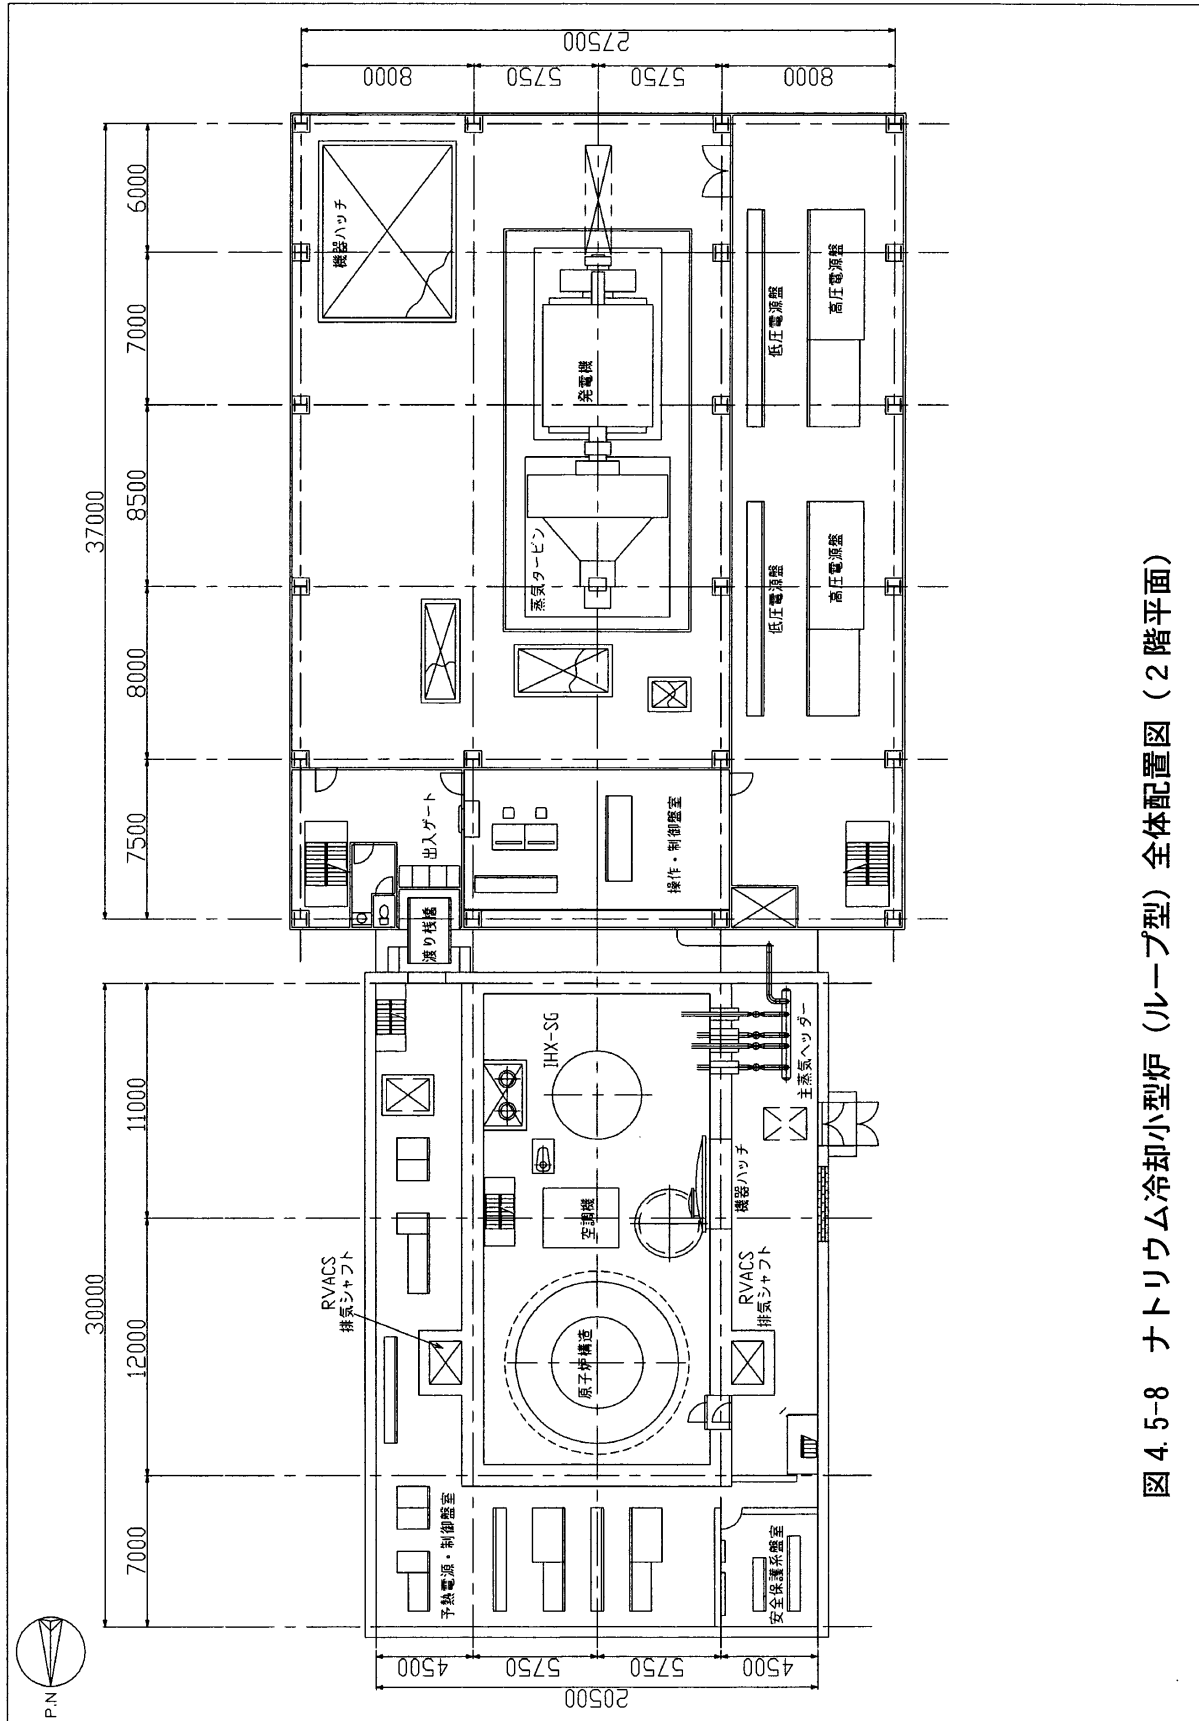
ナトリウム冷却小型炉（ループ型）全体配置図（2階平面）
